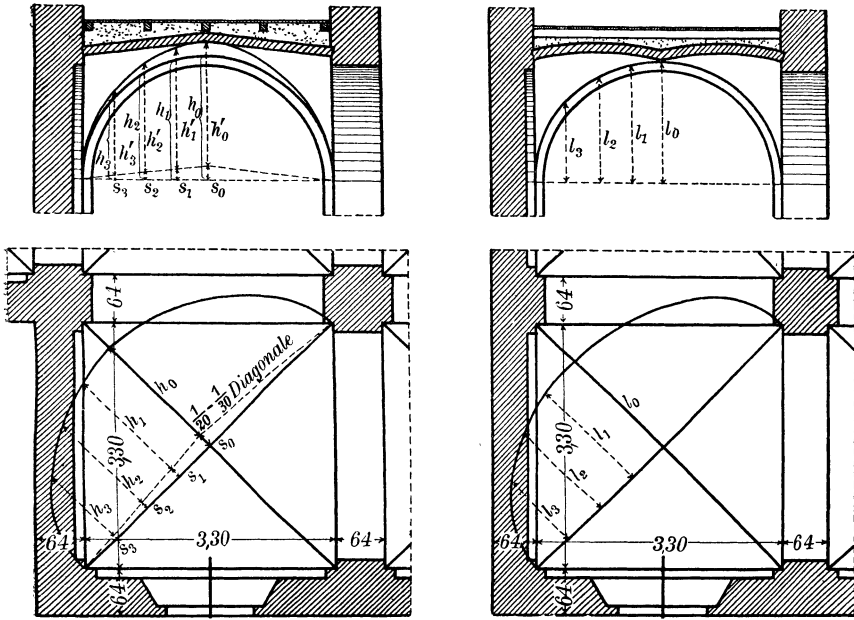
Kreuzgewölbe mit geradem Stich (Grundriß und Querschnitt).
